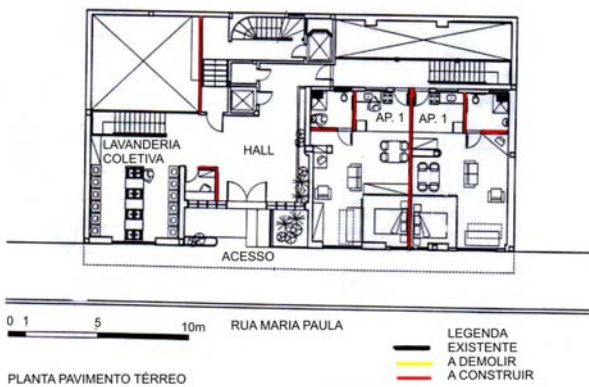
Planta pavimento térreo, Edifício Maria Paula
